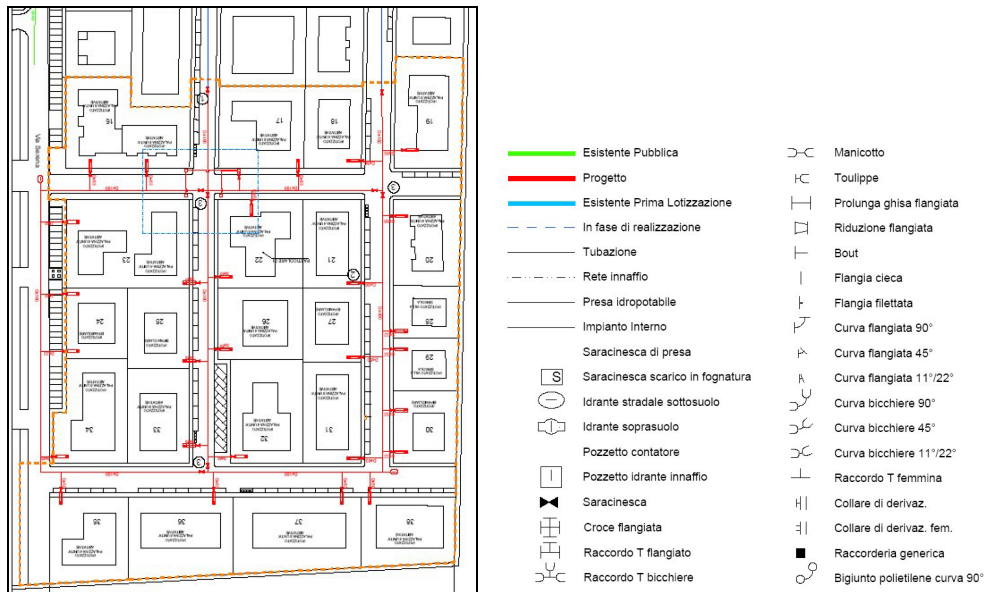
Progetto del piano attuativo (comparto est): planimetria della rete idrica
